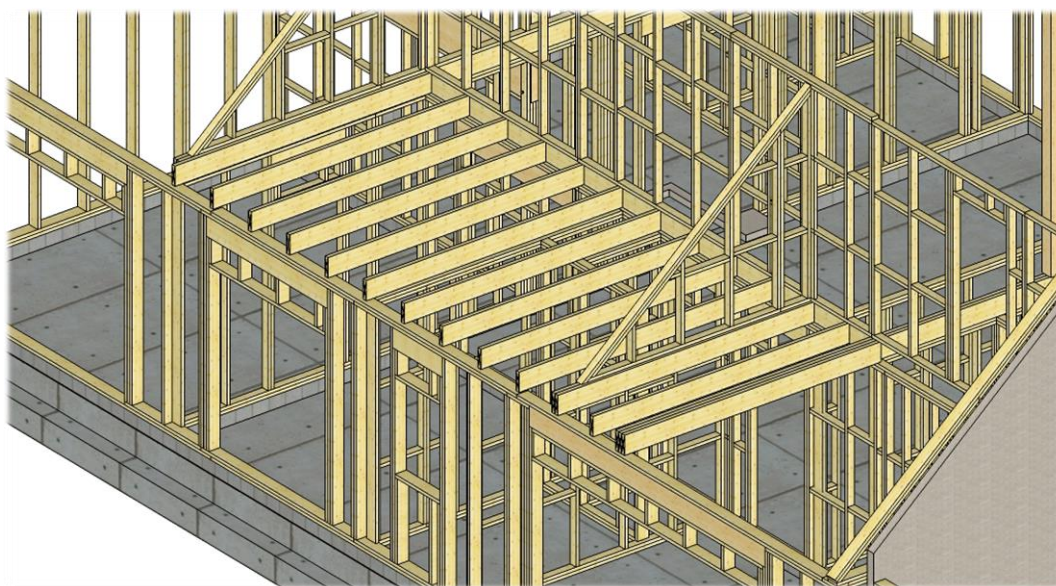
Vigotas em madeira serrada espaçadas por 600 mm, utilizadas no projeto de referência
